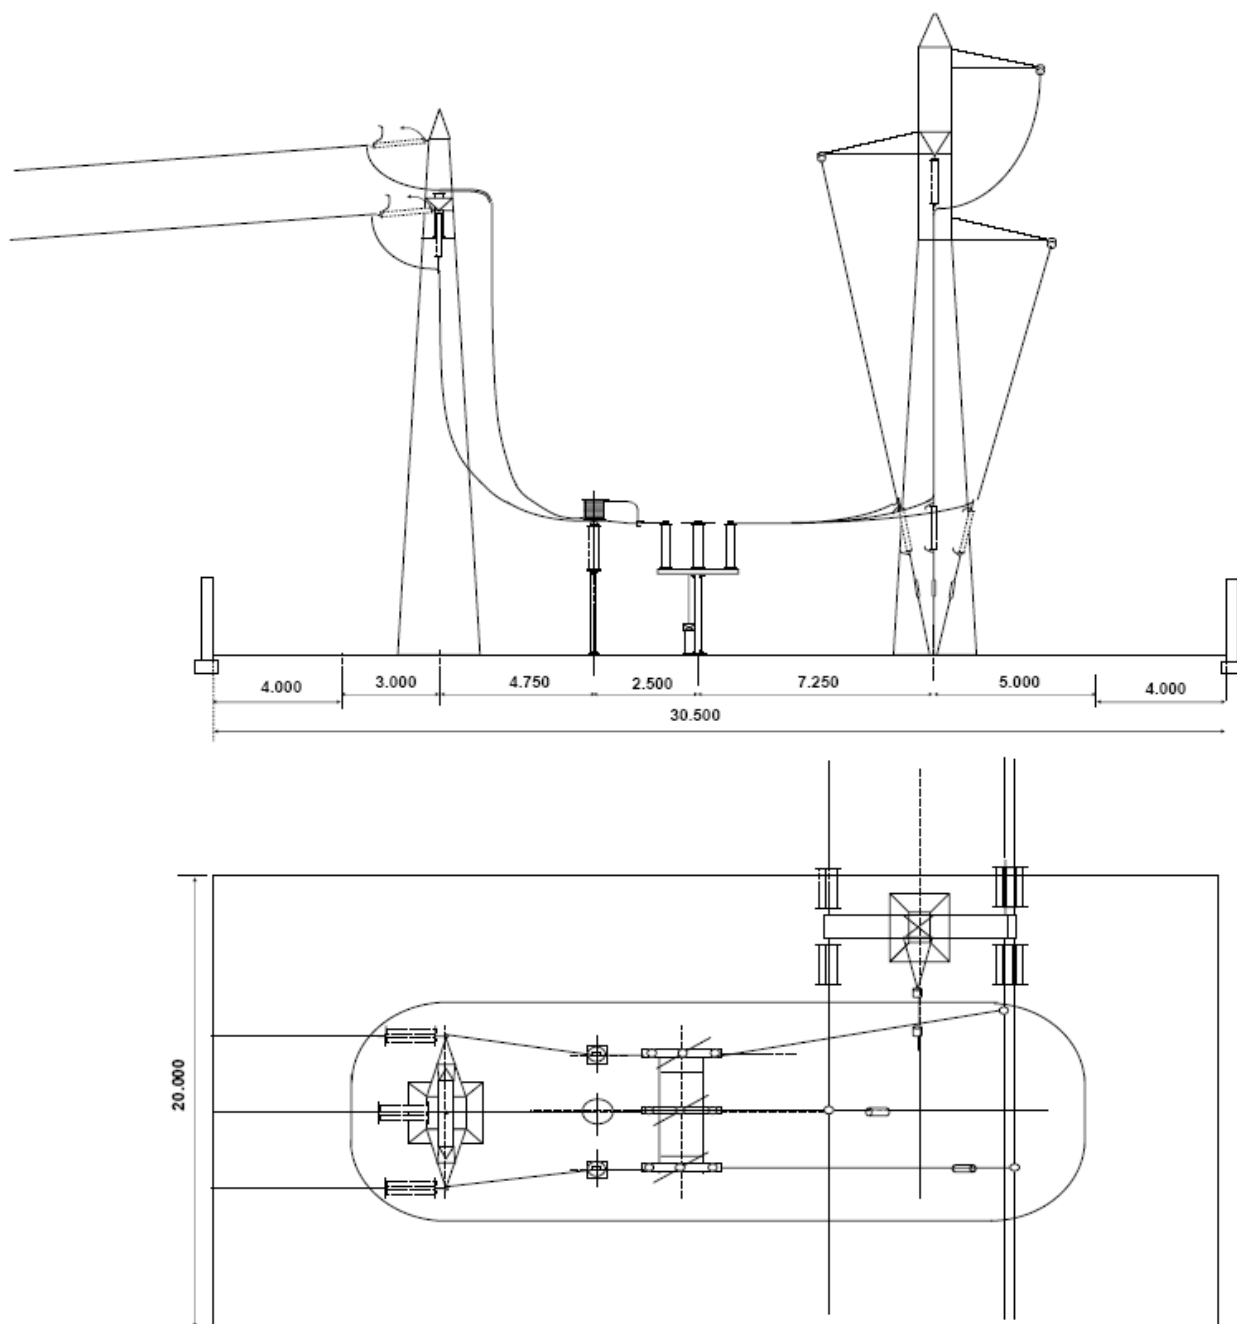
Layout e vista sezionamento per la consegna nel caso di connessione in derivazione rigida a "T"
